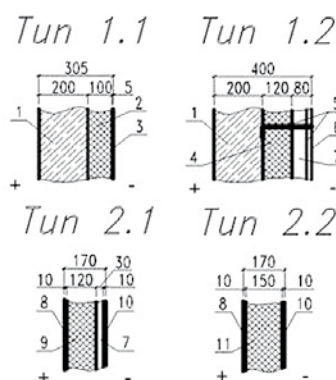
Ограждающие конструкции стен натурных испытательных стендов:
